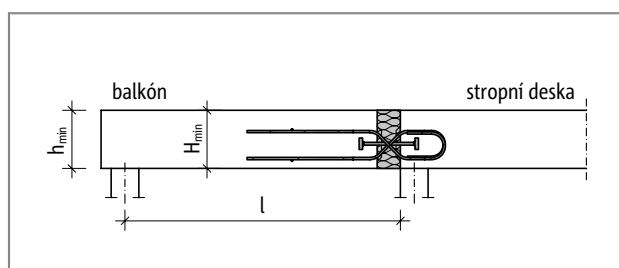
Schöck Isokorb® typ QP20S a QP50M: Statický systém
